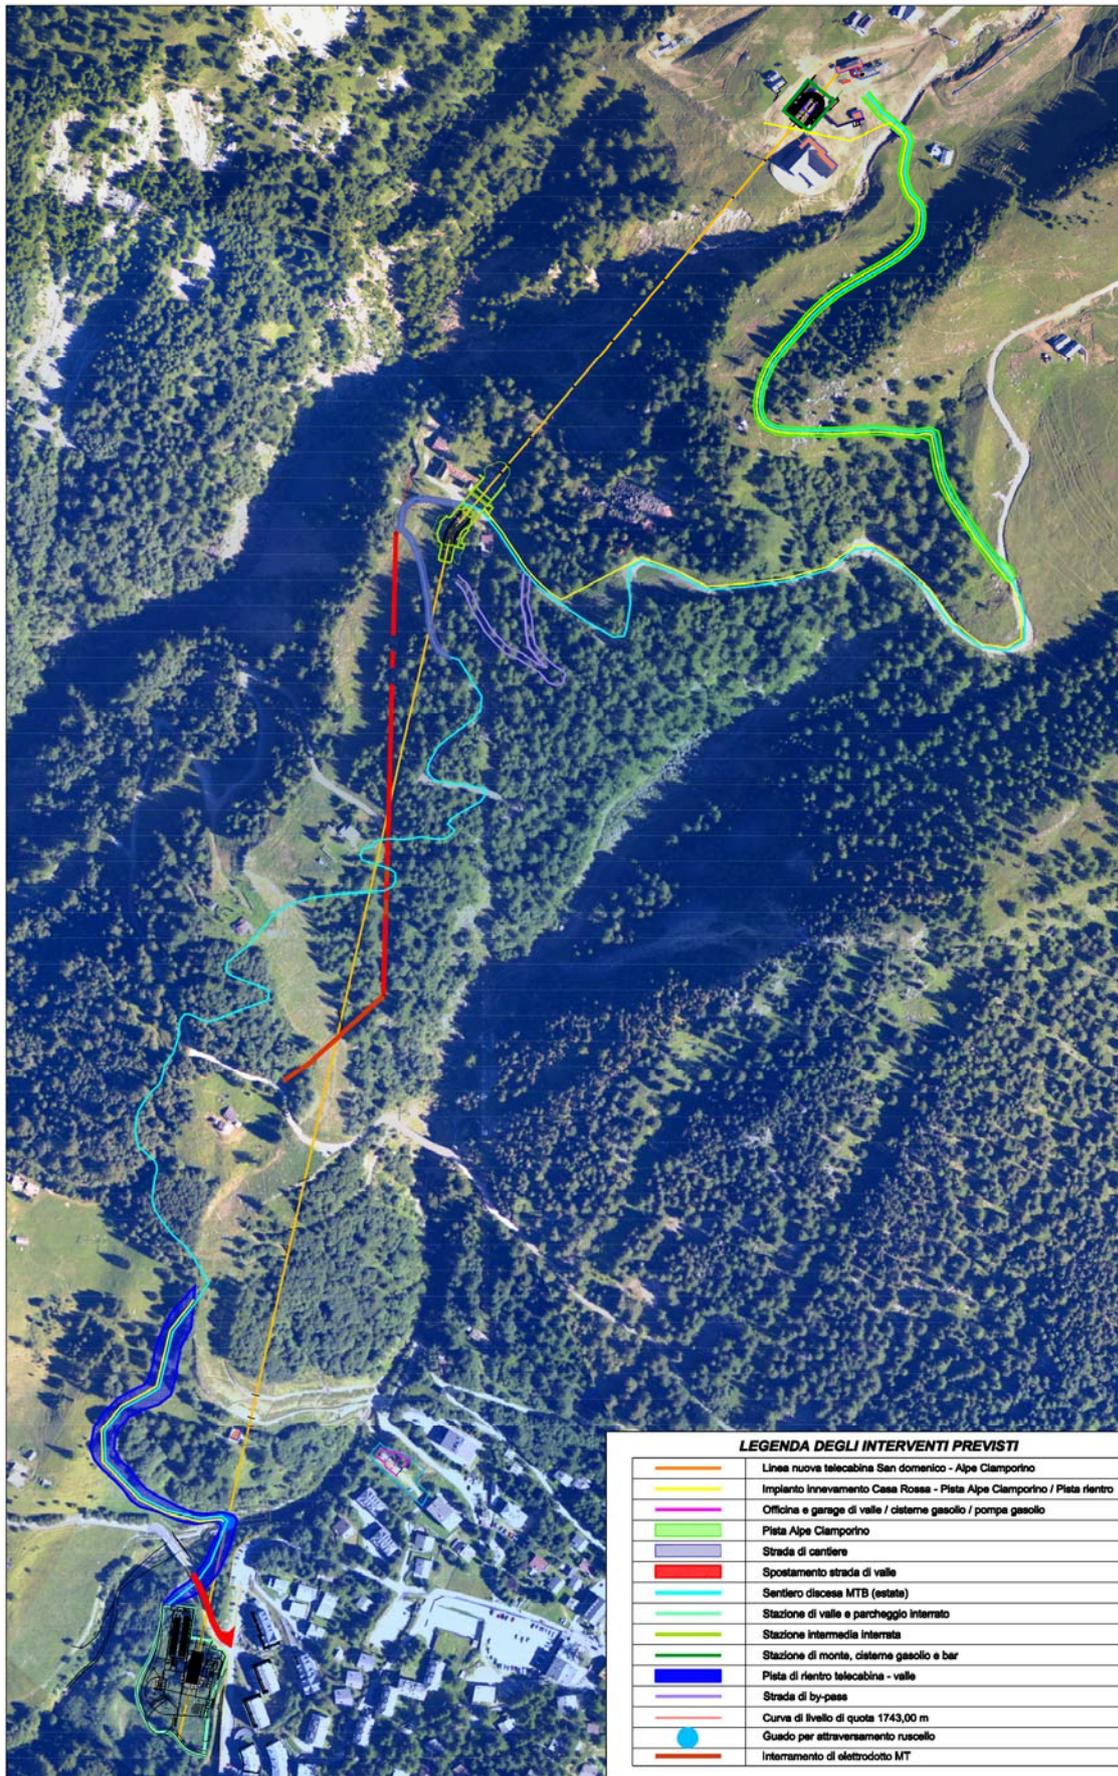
Planimetria di sintesi delle opere in progetto
